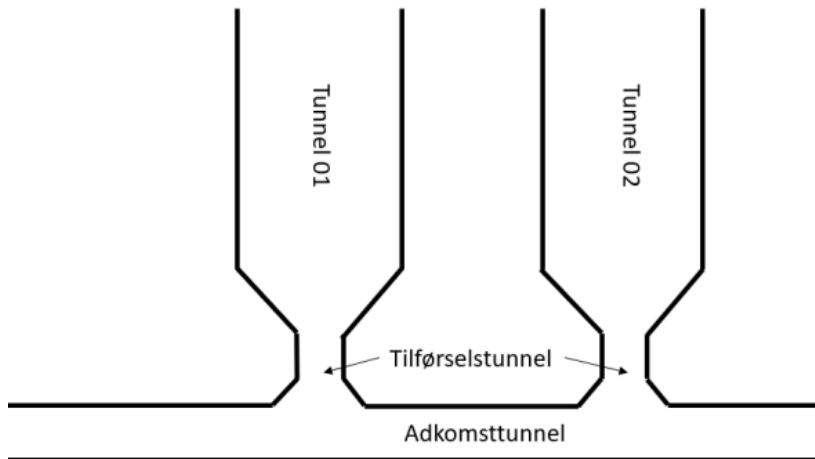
Tilsendt illustrasjon av planlagt fjellhaller. Den minste hallen nærmest er eksisterende fjellhall.
